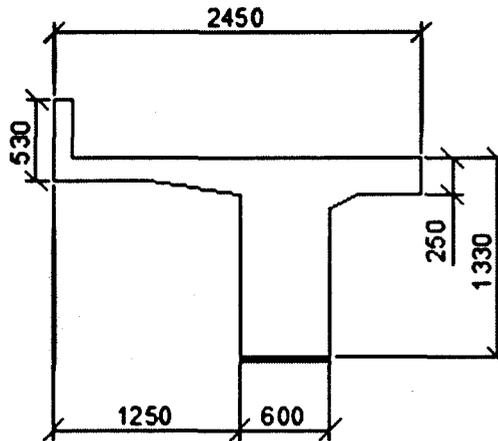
Схема усиления главной балки пролетного строения.
